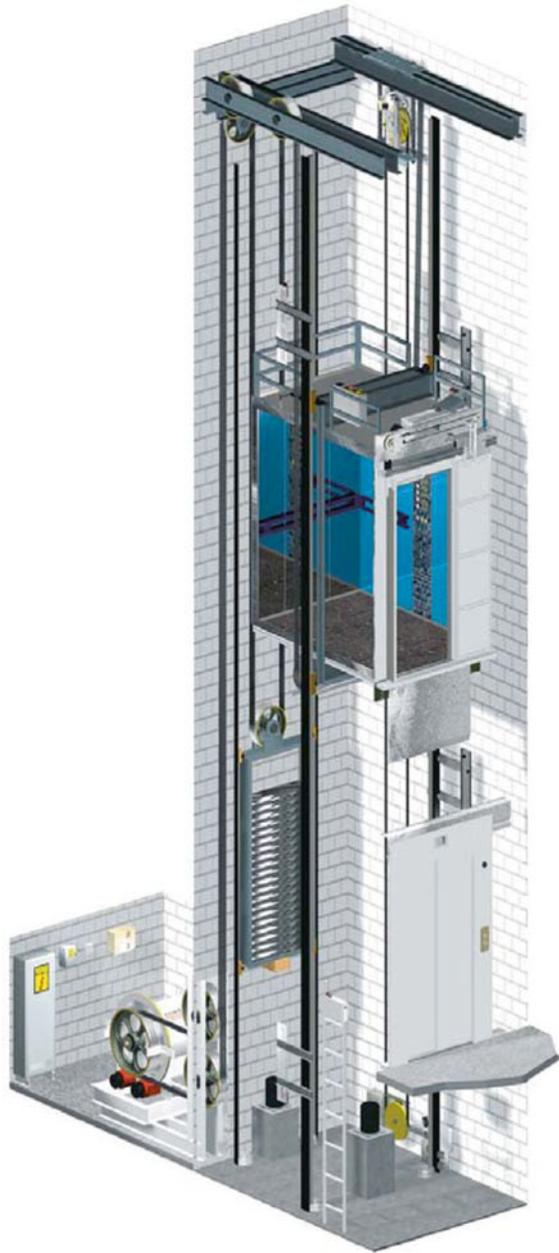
Aufzugsanlage mit Maschinenraum oben über.
